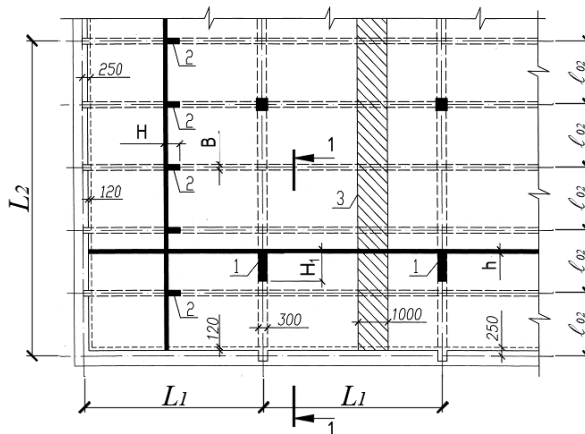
Конструктивная схема перекрытия здания из монолитных железобетонных балочных плит: 1 – главная балка; 2 – второстепенная балка; 3 – расчетная полоса шириной $b = 1000$ мм для расчета плиты на прочность и огнестойкость; L_1 и L_2 – пролеты балочной плиты, мм; H_1 и H – высота сечения главной и второстепенной балки, мм; h – высота сечения плиты, мм; ℓ_{01} и ℓ_{02} – расчетные размеры пролетов балочной плиты, мм; B – ширина второстепенной балки, мм
